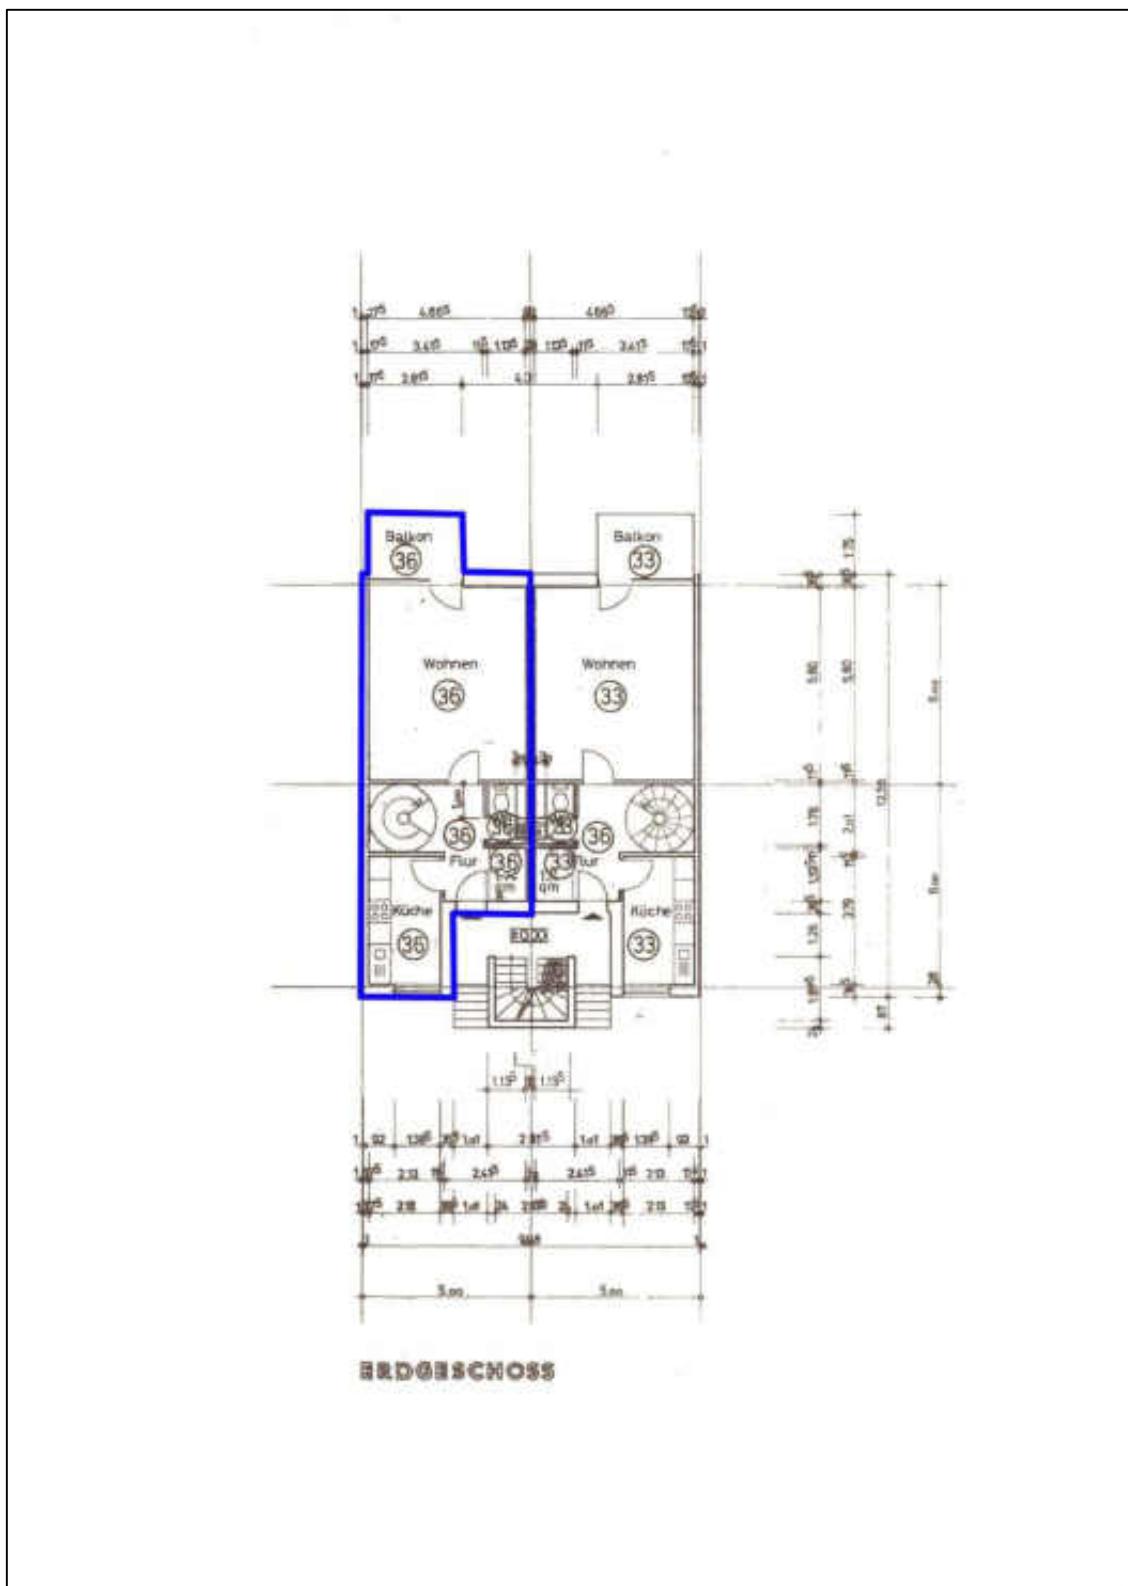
Grundriss vom Erdgeschoss vom Gebäudetyp A
